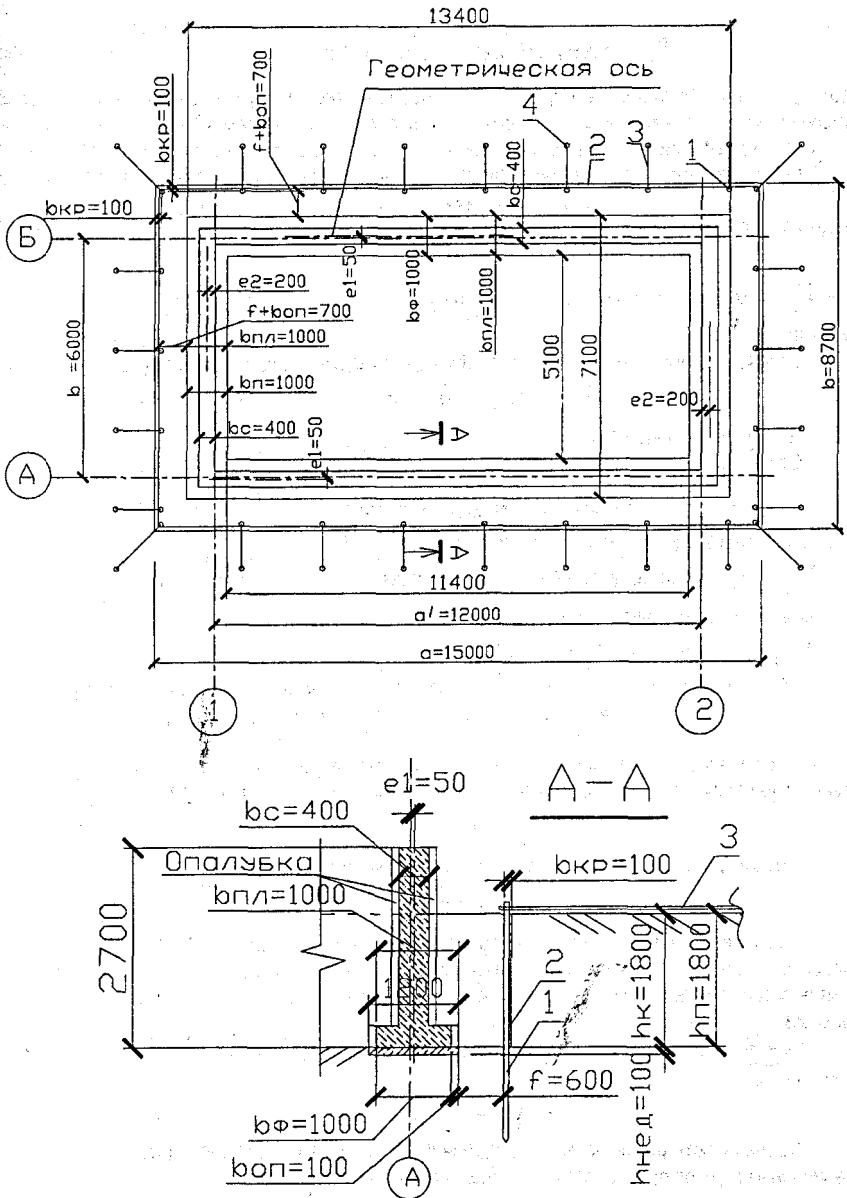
Схема прямоугольного котлована с вертикальными стенками одинаковой глубины в глинистых и суглинистых грунтах (с подготовкой) под монолитные ленточные фундаменты здания с подвалом
